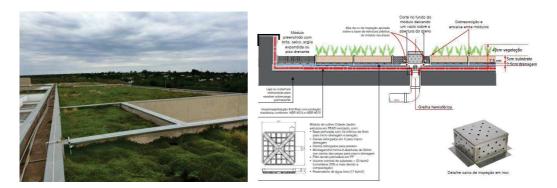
a) Teto verde plantado com a espécie *callisia repens*; b) Corte e detalhamento do teto verde extensivo implantado pelo sistema modular. Fonte a e b): Instituto Cidade Jardim, 2019 - Portfólio de Projetos.
